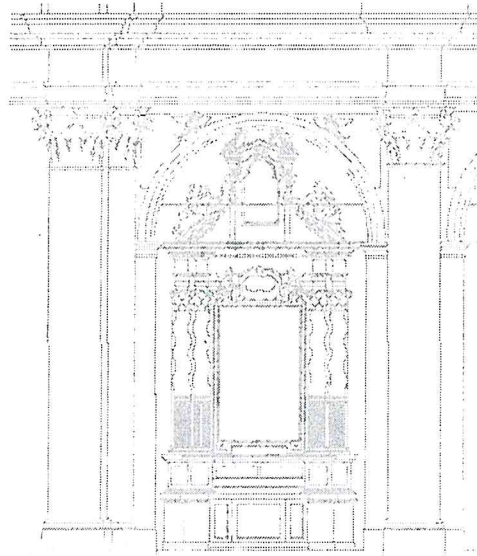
esempio di particolare sezione trasversale (prospetto)
